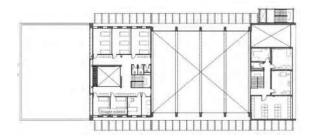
Planta alta Fuente: http://www.archdaily.mx/mx/02-122498/parque-de-bomberosen-valls-santamaria-arquitectes
